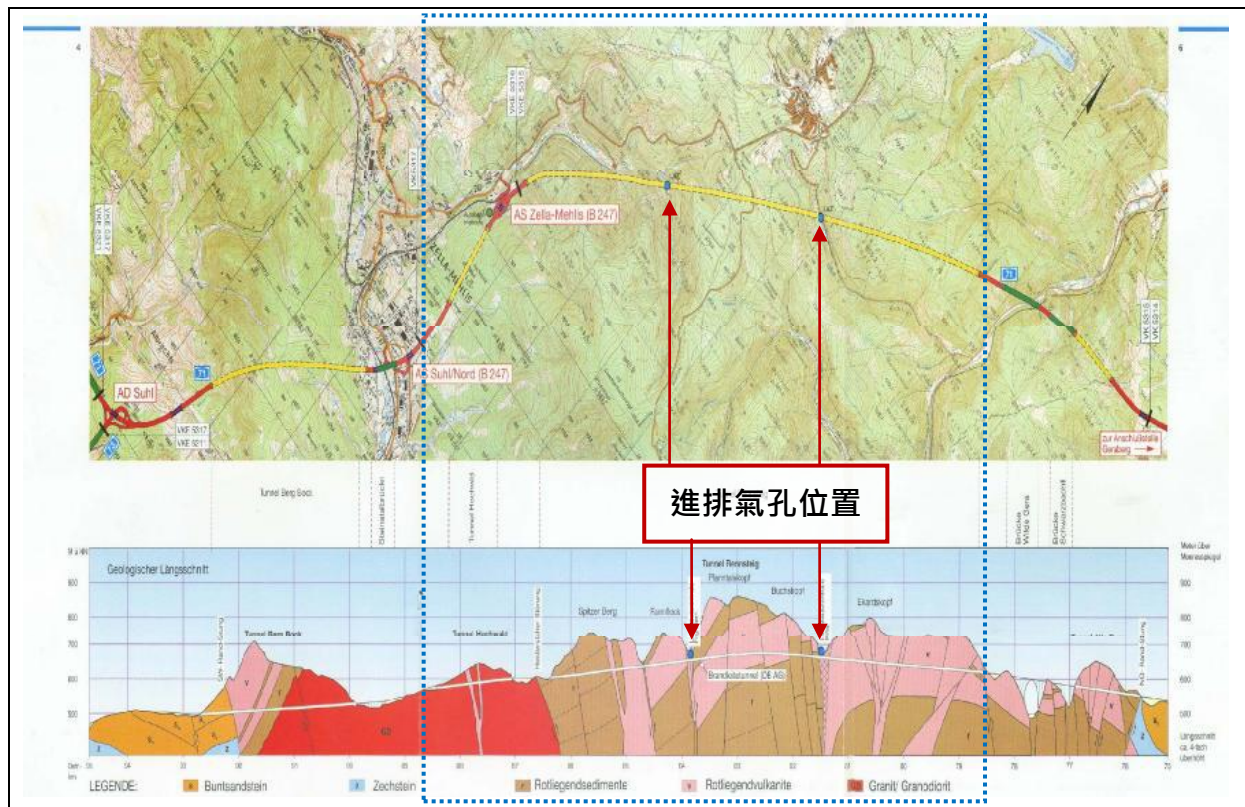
Rennsteig隧道平面圖與斷面圖
